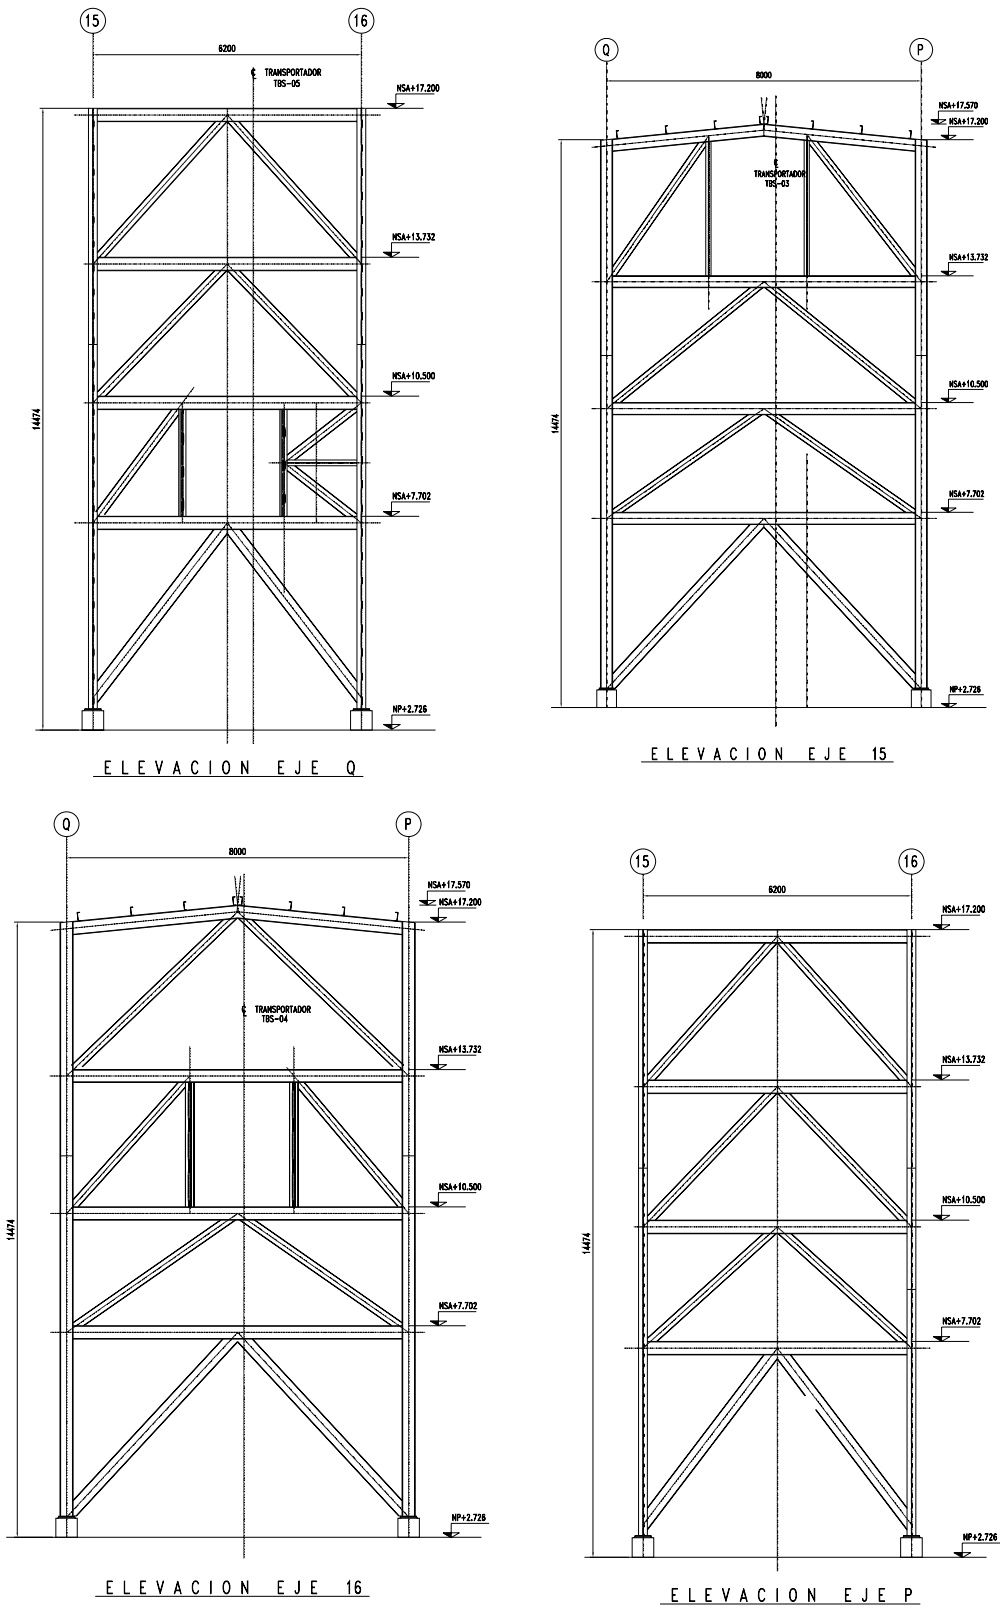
Elevaciones de Marcos Estructurales en Torre TT-4
